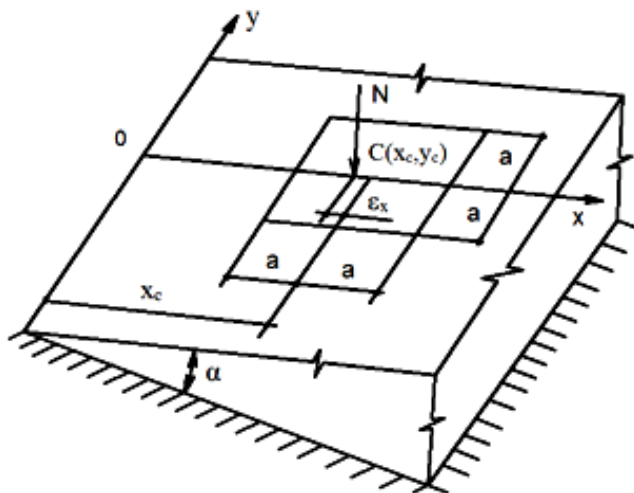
Расчетная схема для трапециевидного фундамента
